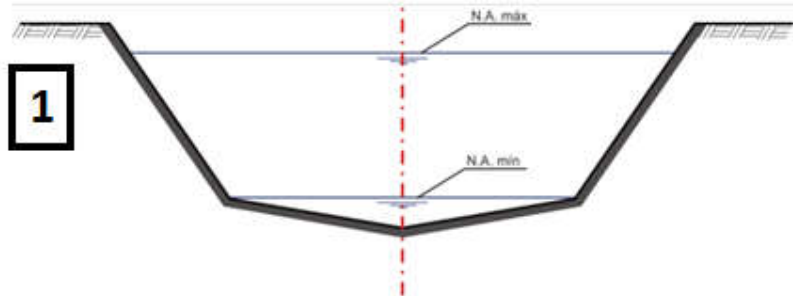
Canal em concreto – Seção trapezoidal mista
